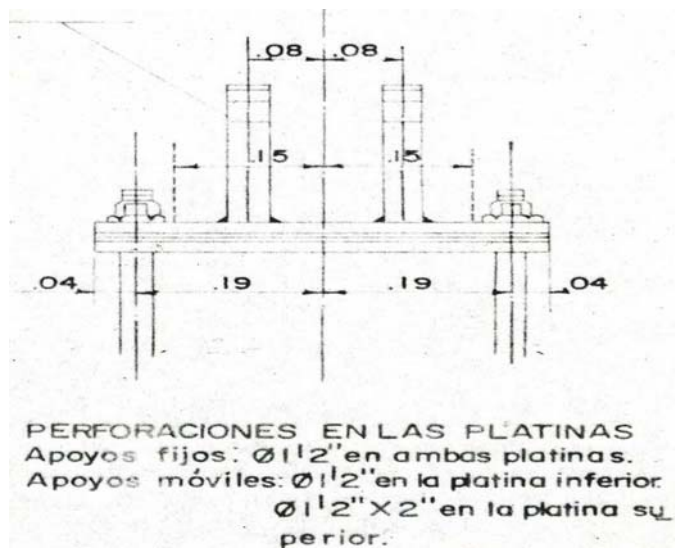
Apoyos de acero estructural empotrados en las vigas.
